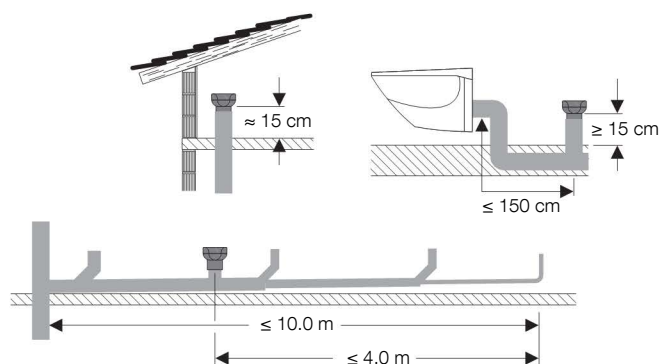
Einbaumasse Geberit Rohrbelüftungsventil GRB90
